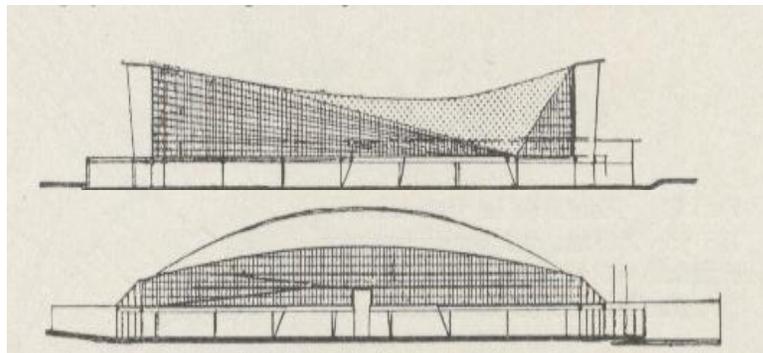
Centro de las industrias mecánicas en París 1951. Cubierta colgante e su sección longitudinal y abovedada en la sección transversal.²⁴
